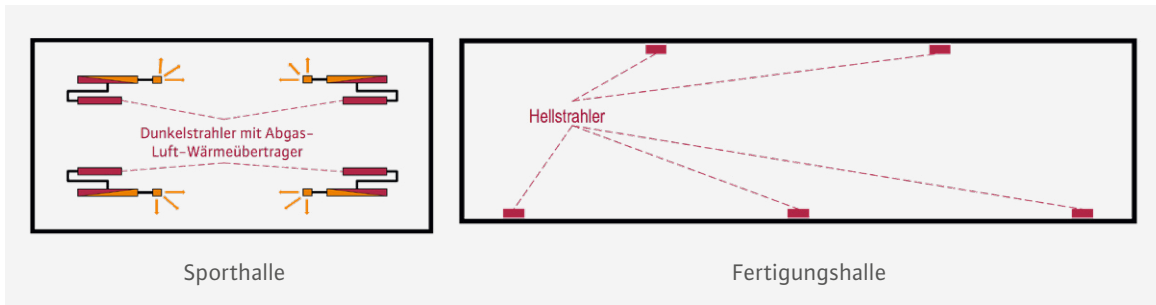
Hallengrundrisse, vereinfachte Darstellung
